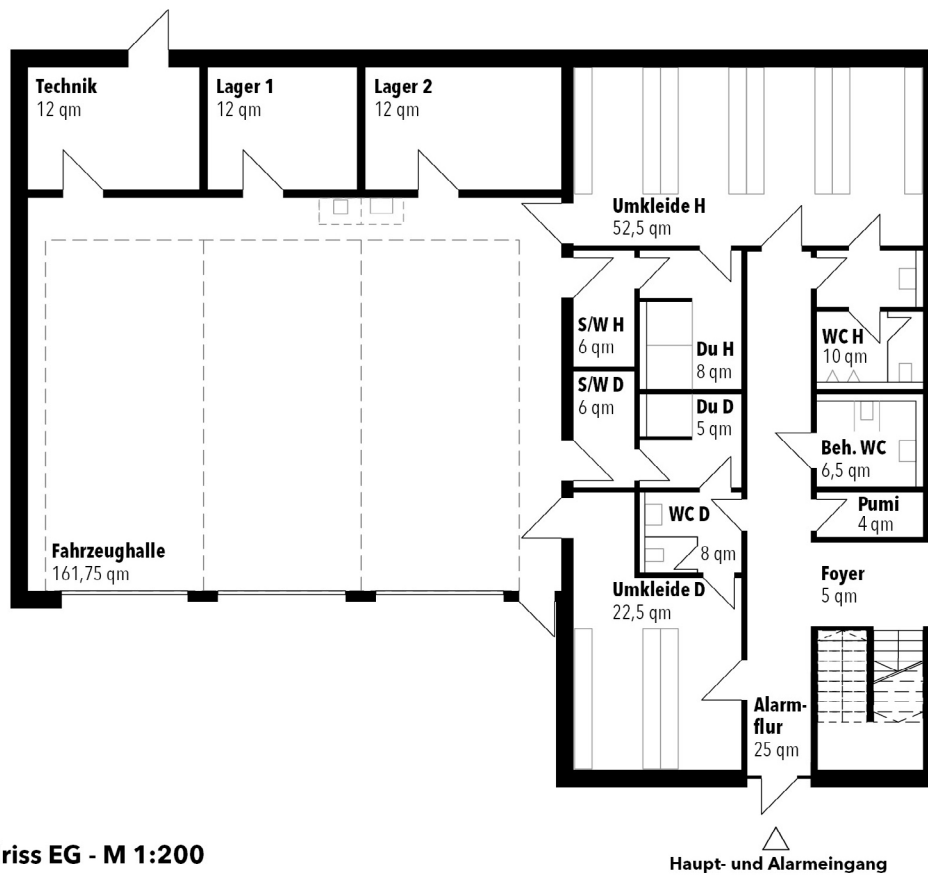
Musterraumprogramm 3 Stellplätze zweigeschossig (UG), Grundrissplan
